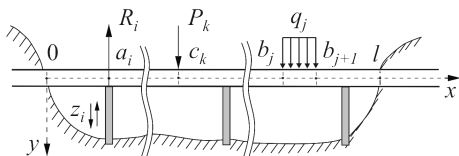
Схема трубопроводу в зоні надземного переходу.
